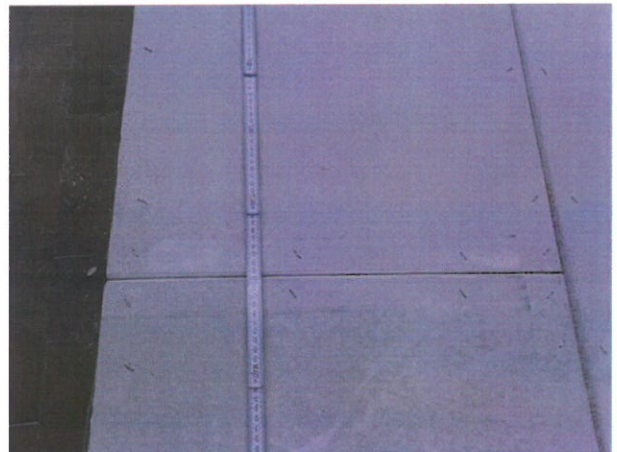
Horizontalstoß der Feuerschutzplatten.
